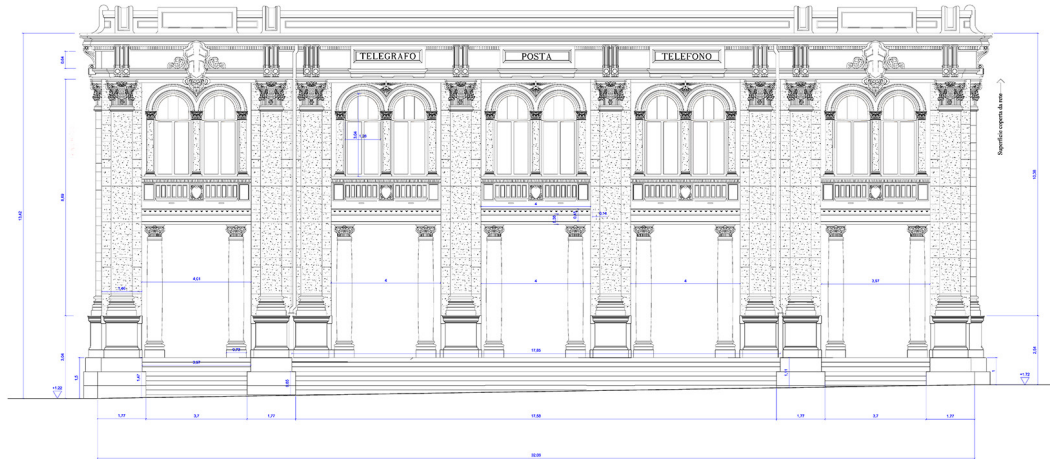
Prospetto su piazza Antonello. Elaborazione grafica dell'autore.
